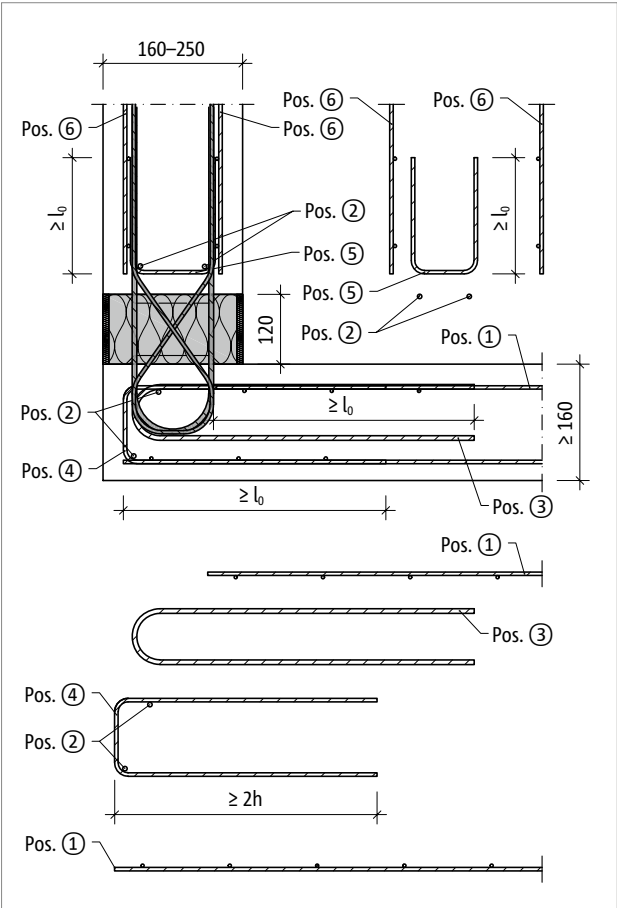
Schöck Isokorb® XT Typ AP vertikale Anordnung: Bauseitige Bewehrung
